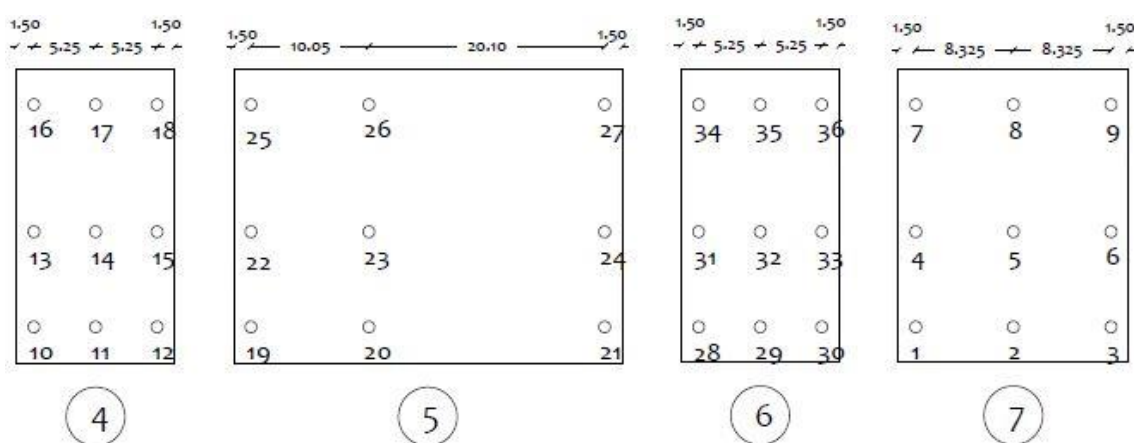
Localização das coordenadas nas fachadas 4,5,6 e 7
